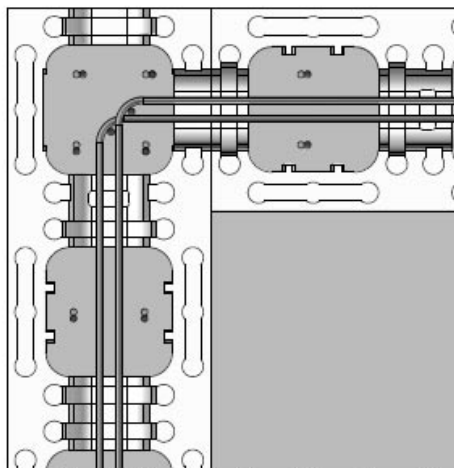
Dispositions de ferrailage dans les angles paroi/paroi
